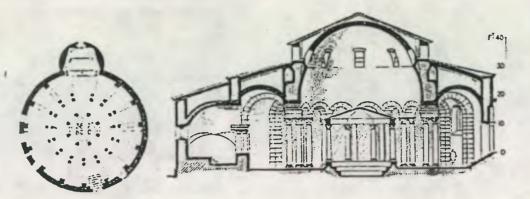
Nocera, Rávena. Planta y sección del Bautisterio.
